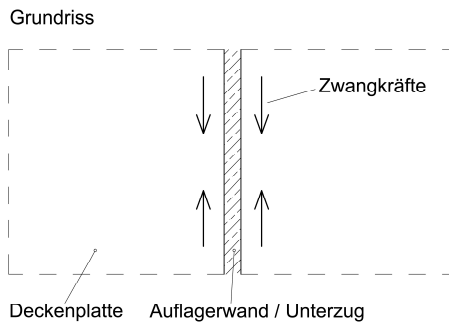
Zwängung einer Stahlbetondecke in der Nähe der das Auflager bildenden Wand / Unterzug
